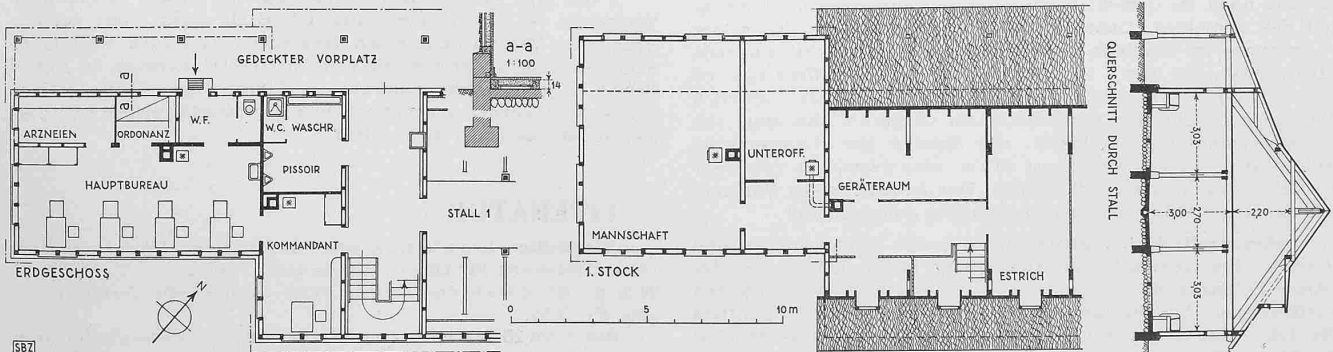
Grundrisse vom Kopfbau-Erdgeschoss und Obergeschoss, rechts Schnitt der Stallungen. — Masstab 1:250
